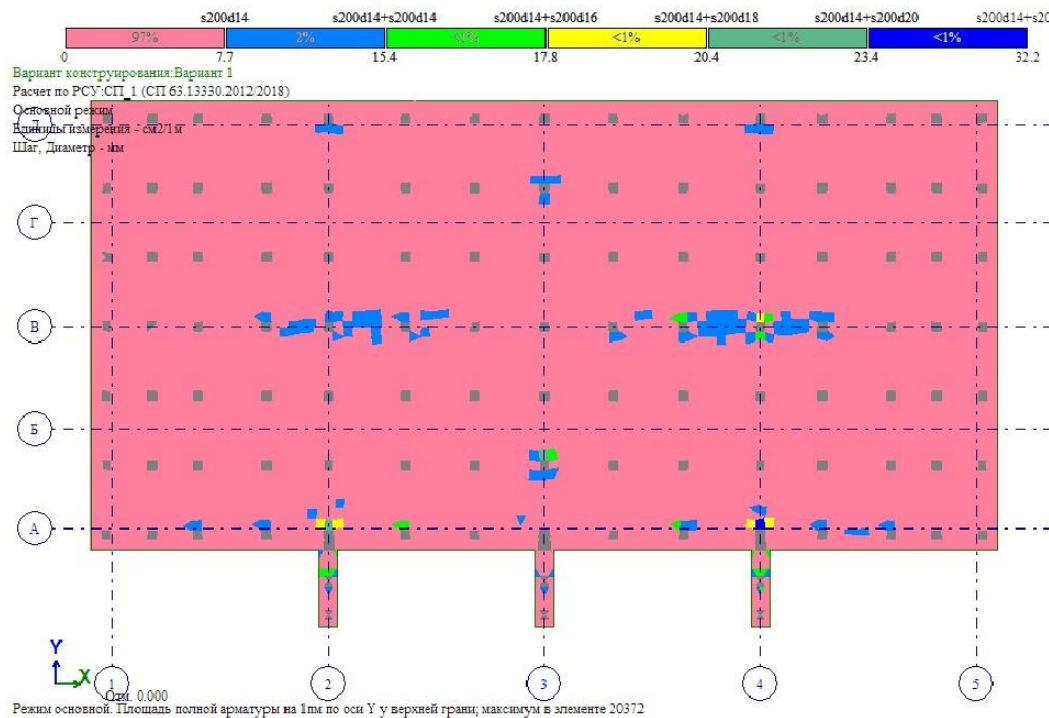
Требуемое верхнее армирование ростверка вдоль оси Y
